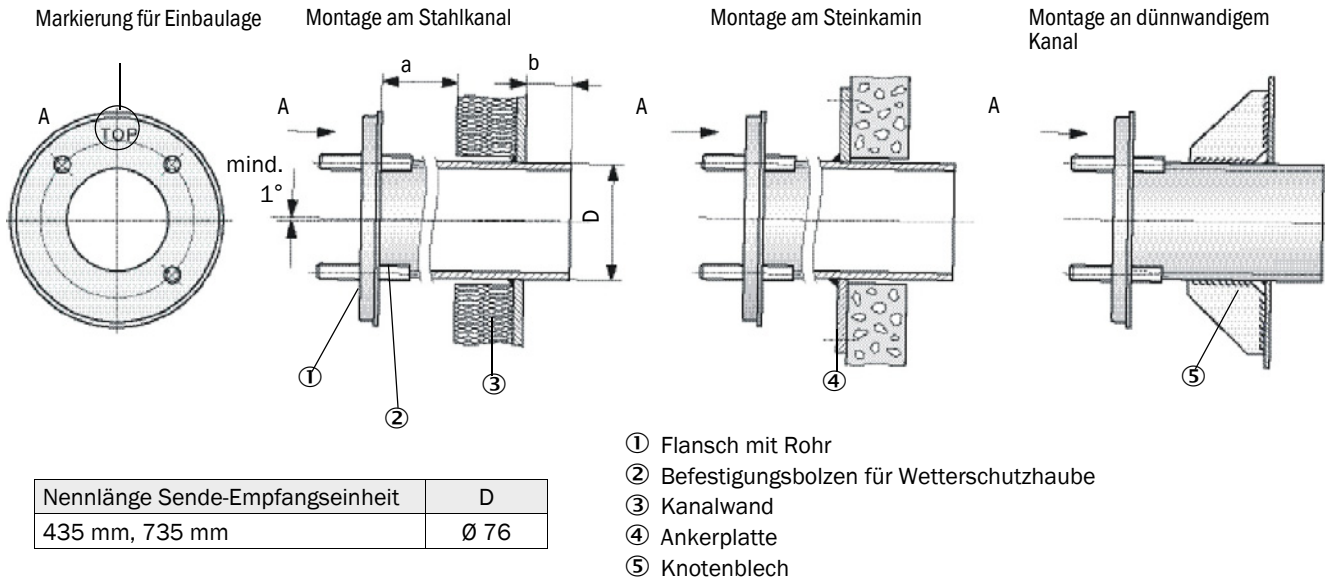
Einbau des Flansches mit Rohr (Darstellung für Standardausführung)
